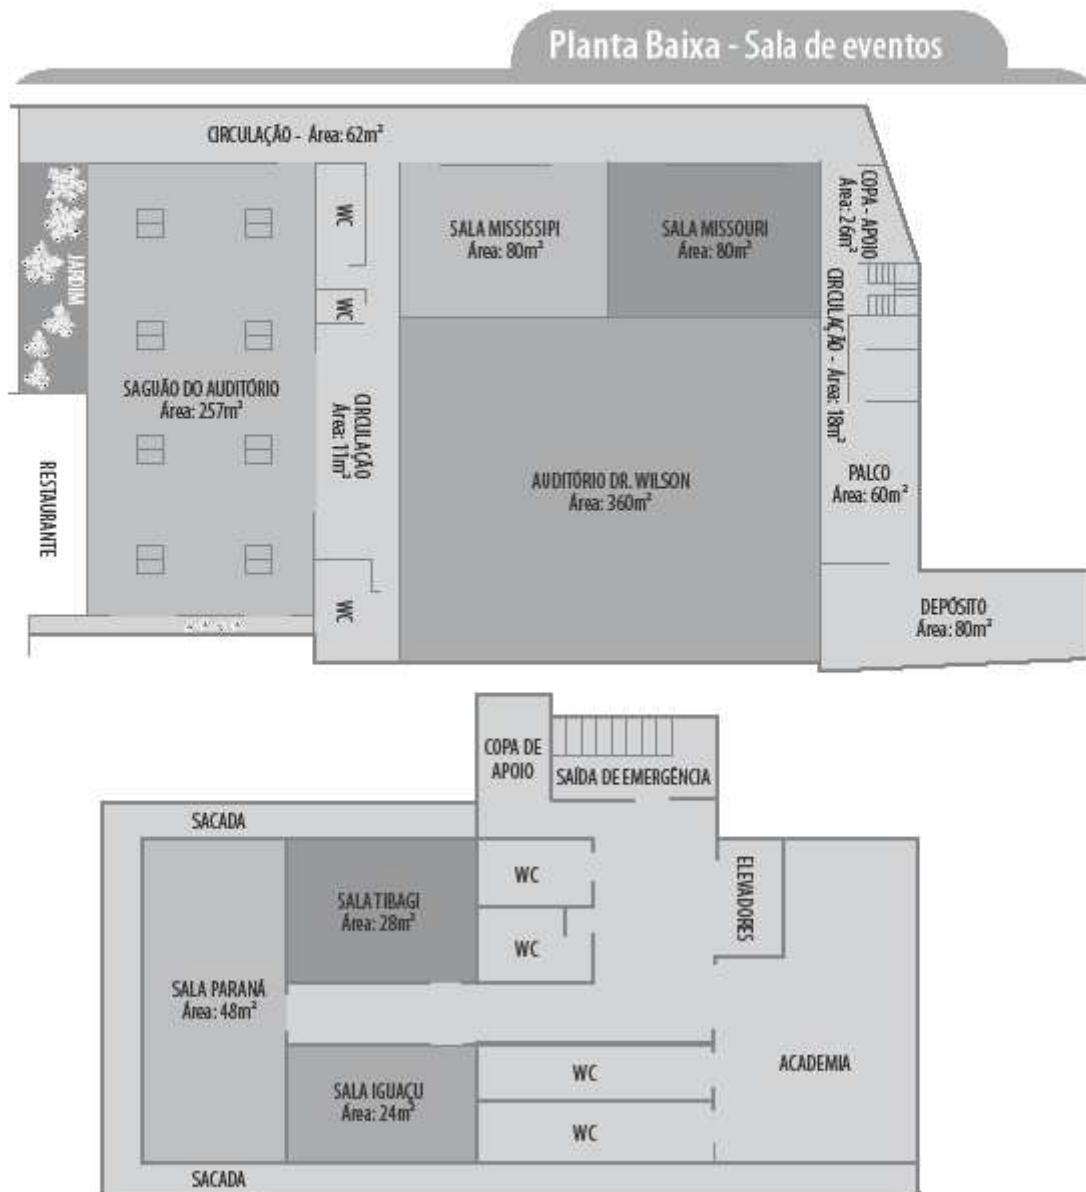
Fonte: Slaviero Executive Ponta Grossa.
